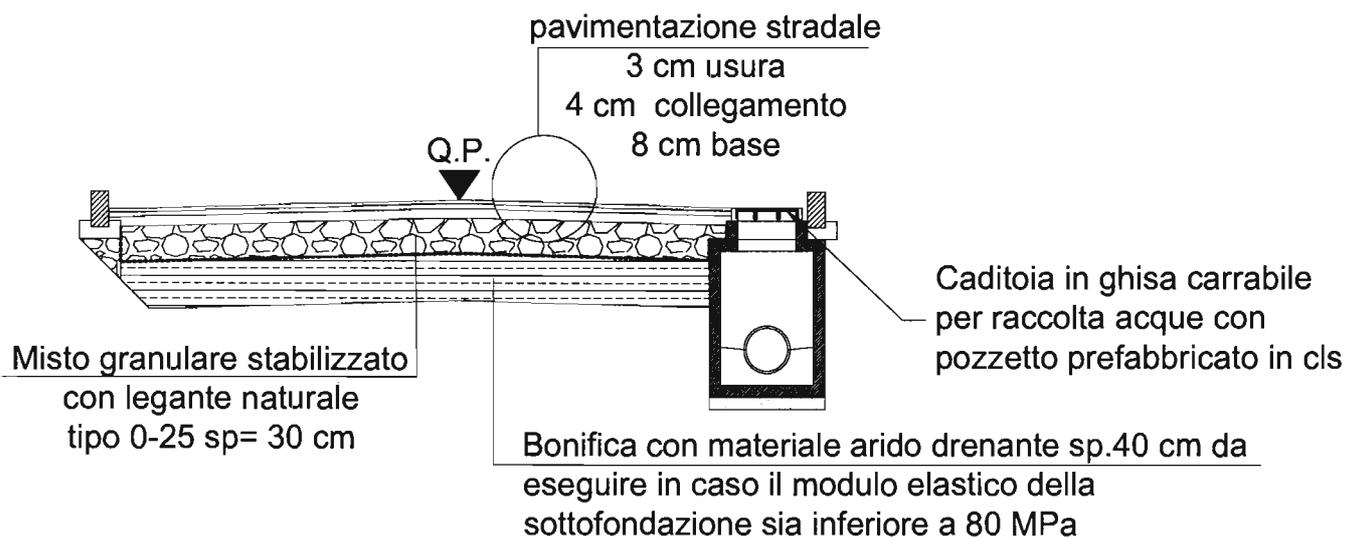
Pavimentazione per Strada di Cantiere Fase Finale
